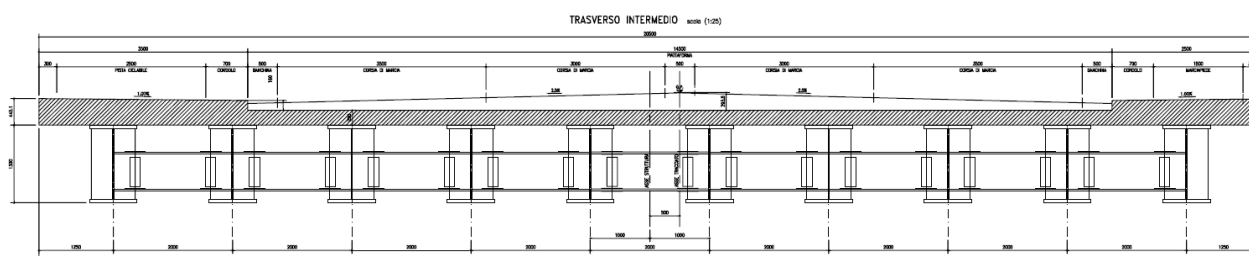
Sezione tipo del traverso intermedio (T2)
